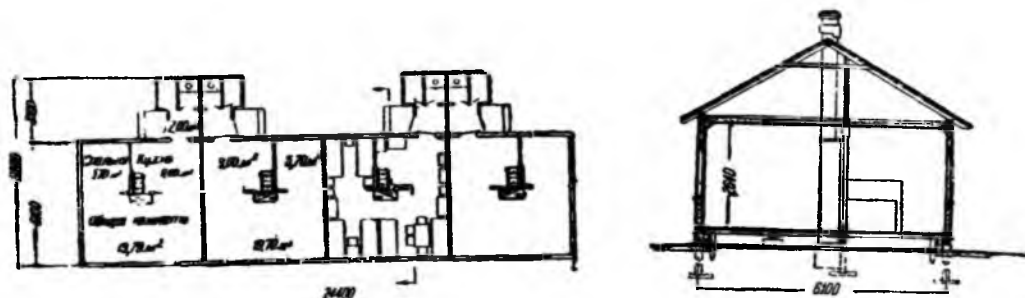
План и разрез четырехквартирного одноэтажного жилого дома с печным отоплением
